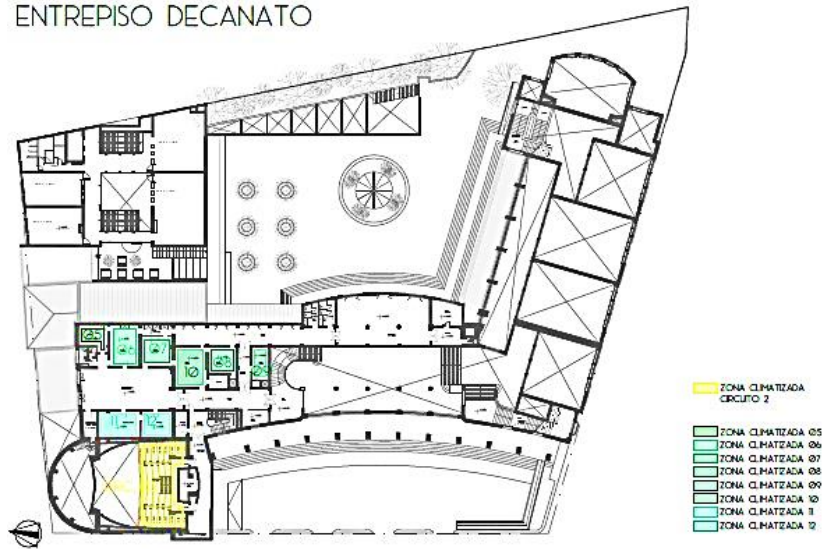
Planta esquema zonas climatizadas Entrepiso.
